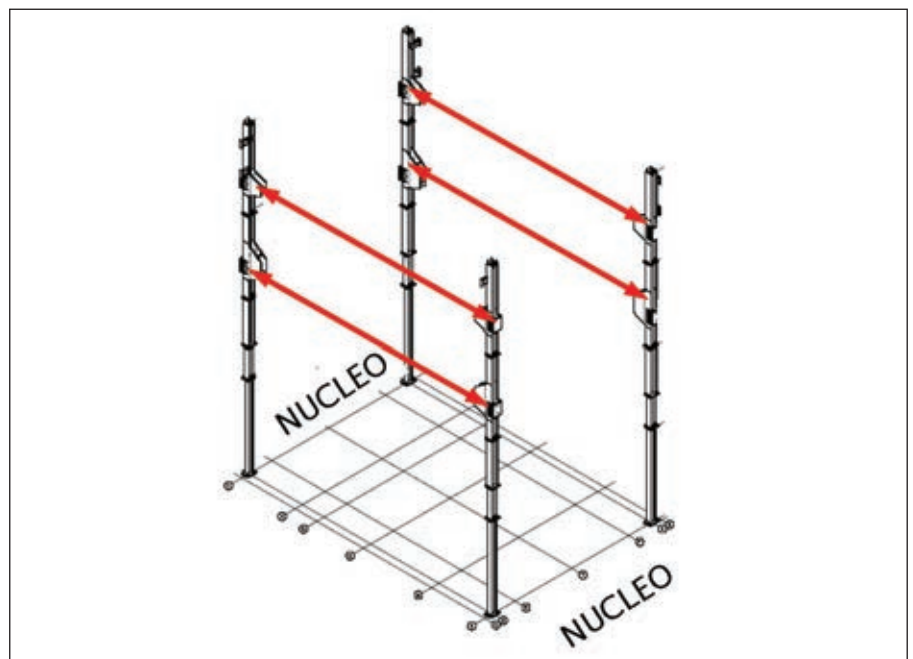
Columnas embebidas con cartelas de montaje a las que se conectan las cerchas principales
